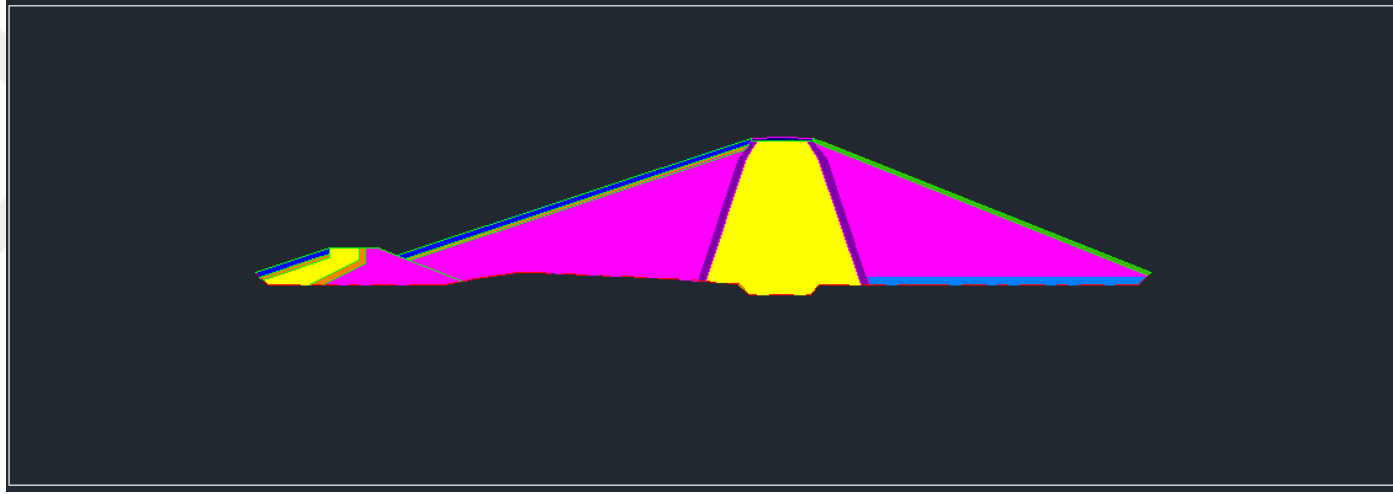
Metraj alan hesaplama – Kesit 2
